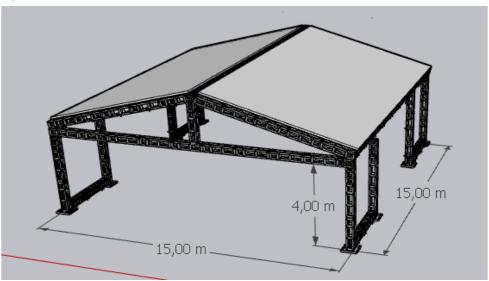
PAVILHÃO RECREAÇÃO (VISTA ESTRUTURA)
